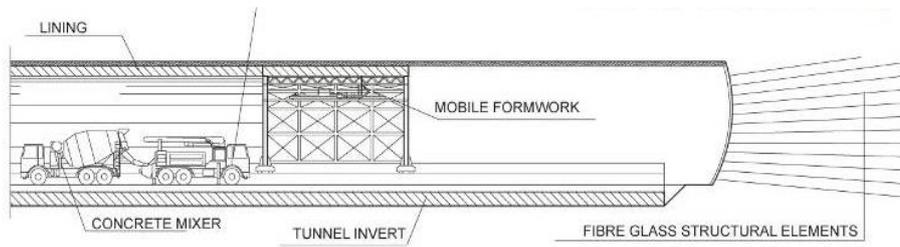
Fase D.1 – Getto rivestimento definitivo – getto arco rovescio e murette.
